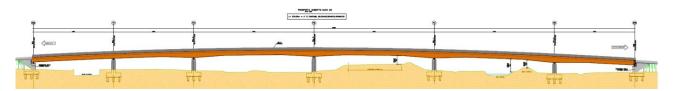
Ponte sul F. Retrone – Profilo longitudinale.
